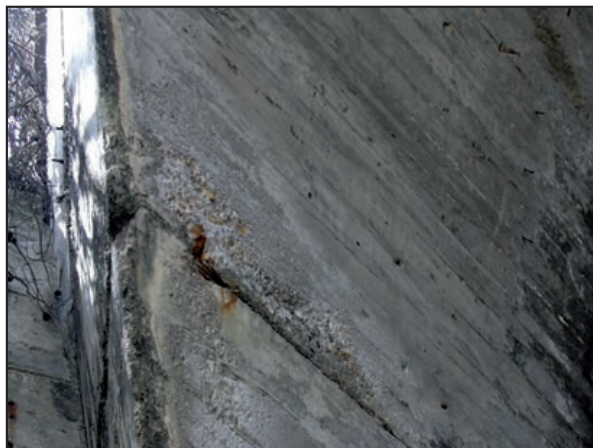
FISURA Y POSTERIOR DEGRADACIÓN DE LA ZONA DE JUNTA DE HORMIGONADO
